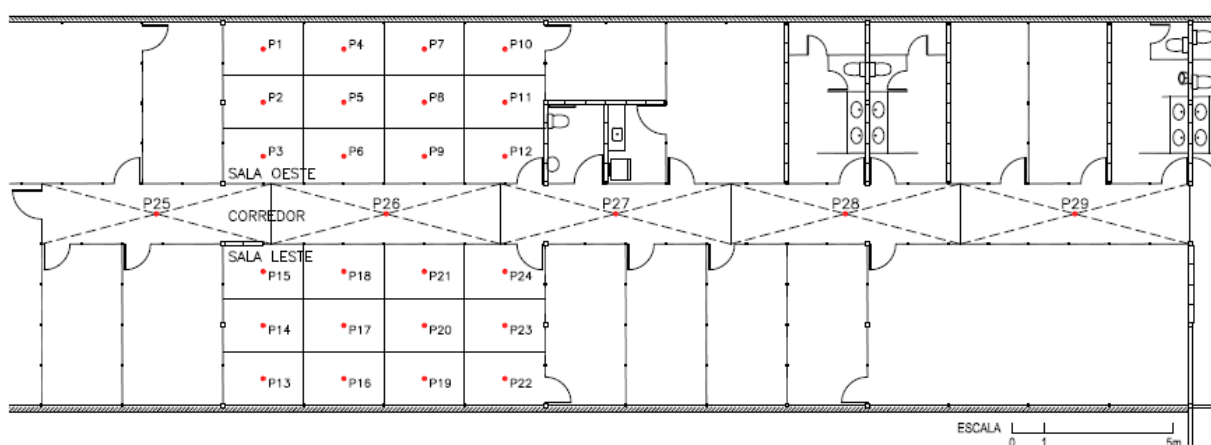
Planta esquemática com a localização dos pontos de medição para avaliação do conforto térmico.
